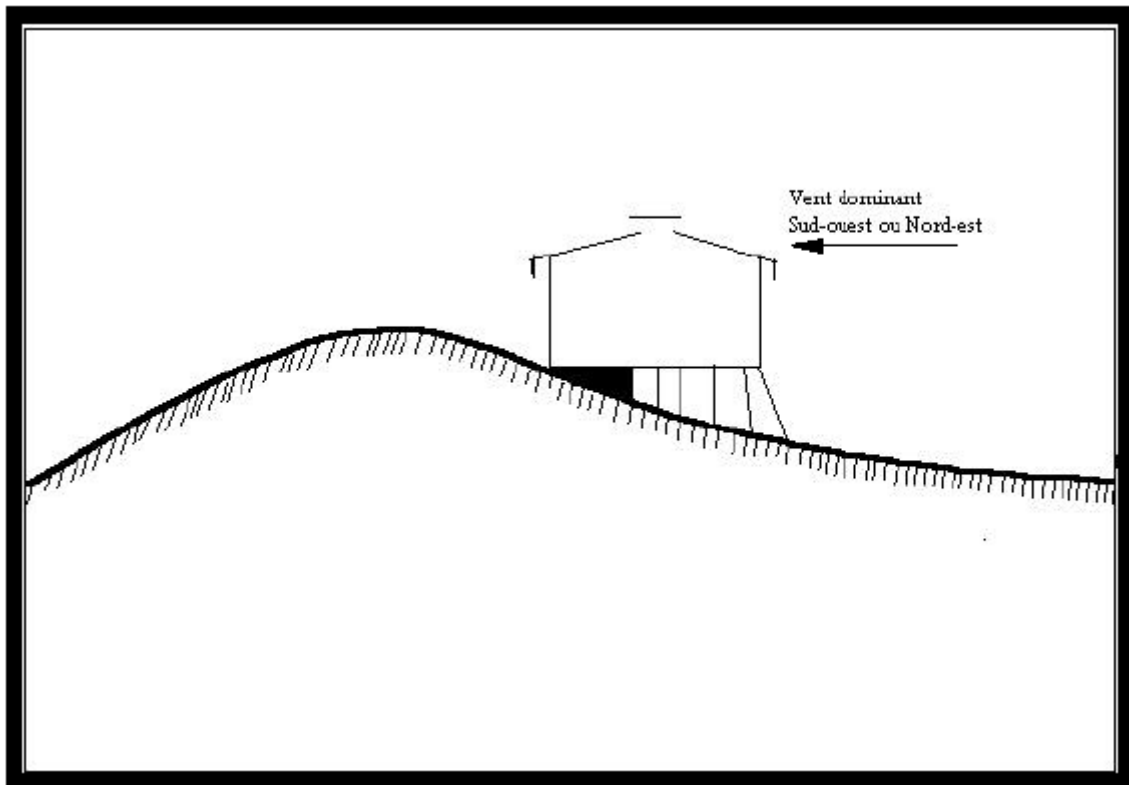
Implantation d'un bâtiment sur une colline (ROSSET R., 1988)
